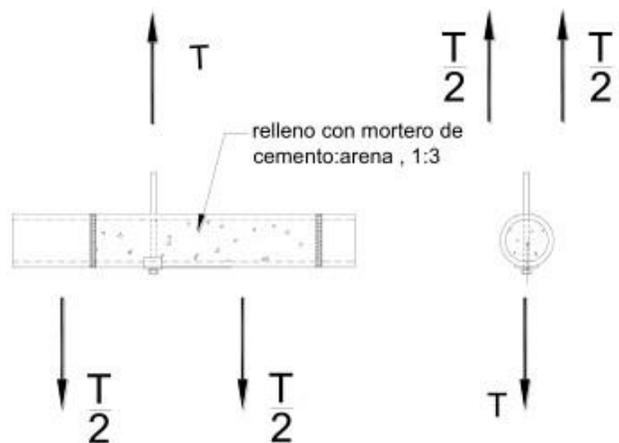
Unión de bambú con cargas a compresión perpendiculares a la fibra, tipo T
